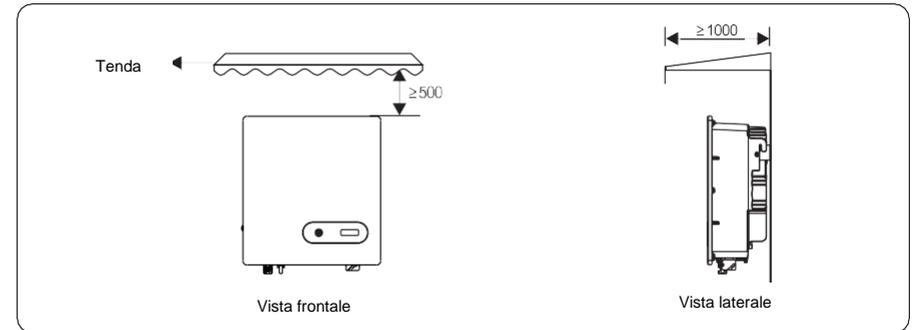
Ambiente di installazione con tenda (unit: mm)
